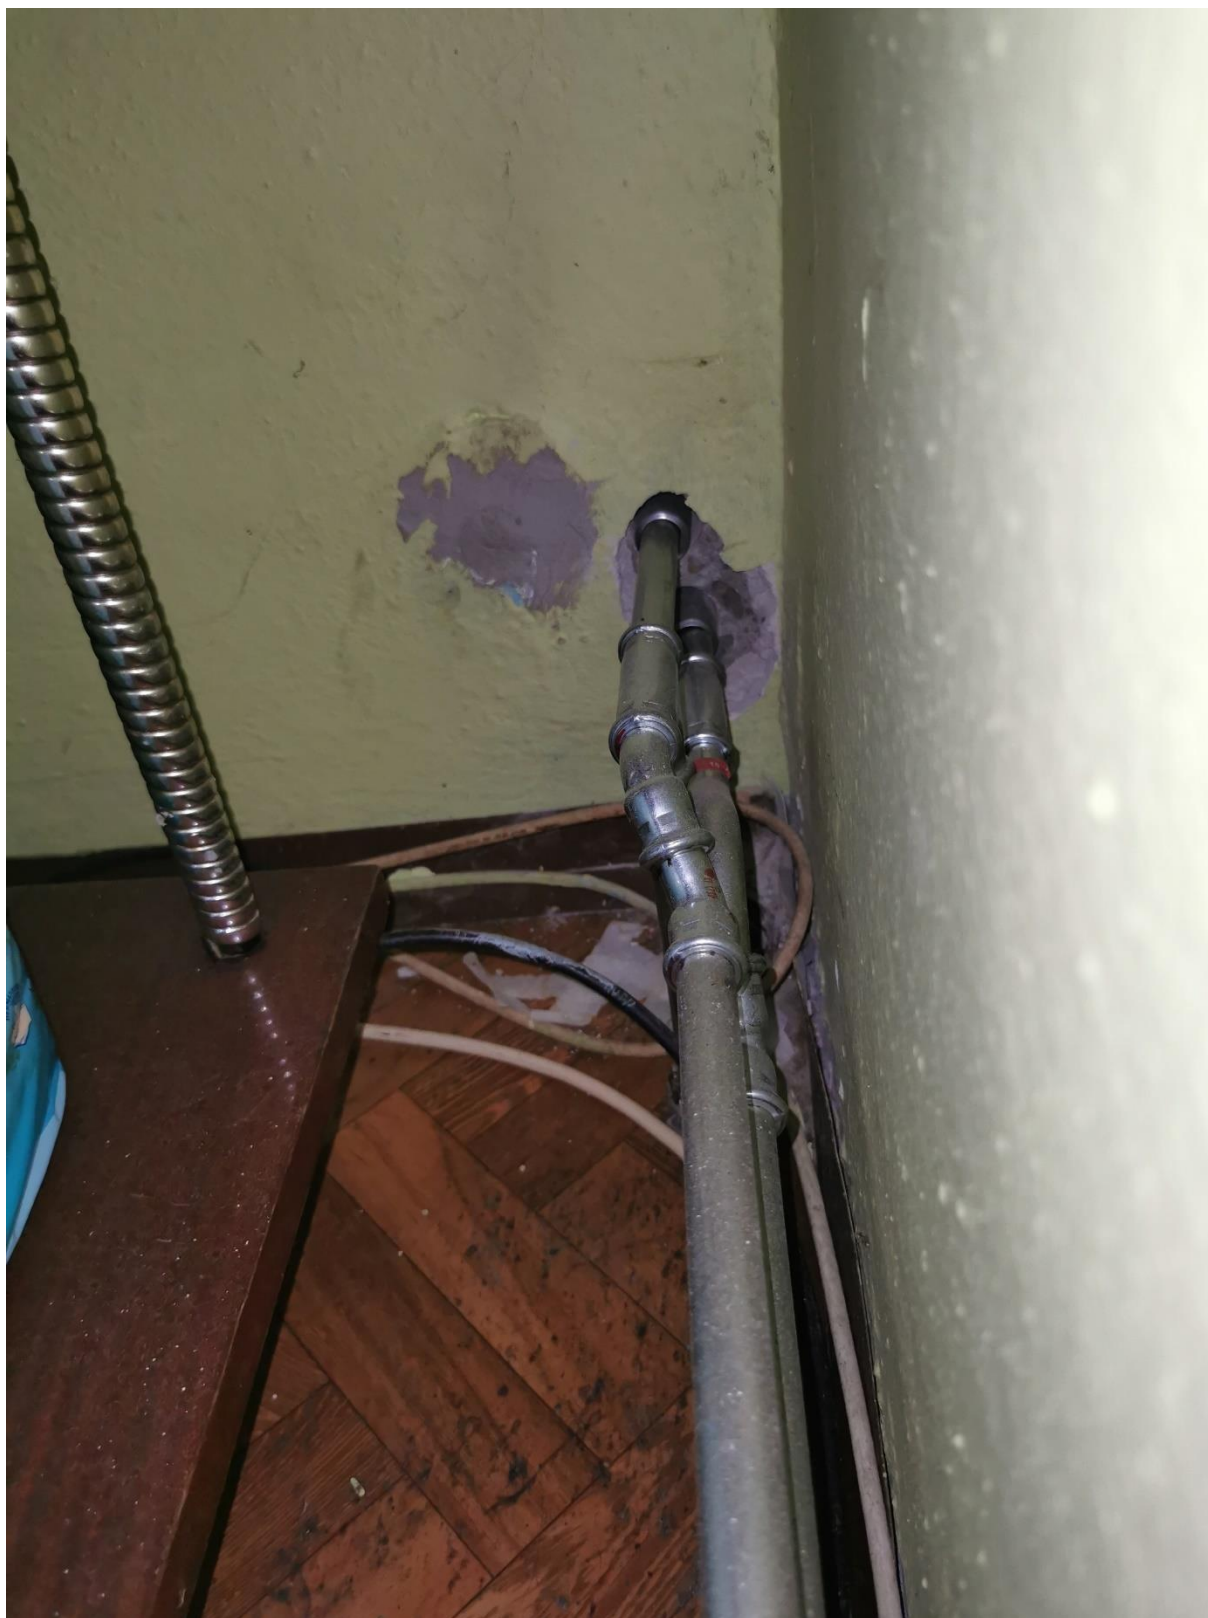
3.23C – brak odtworzenia do stanu pierwotnego przejścia instalacji przez ścianę
